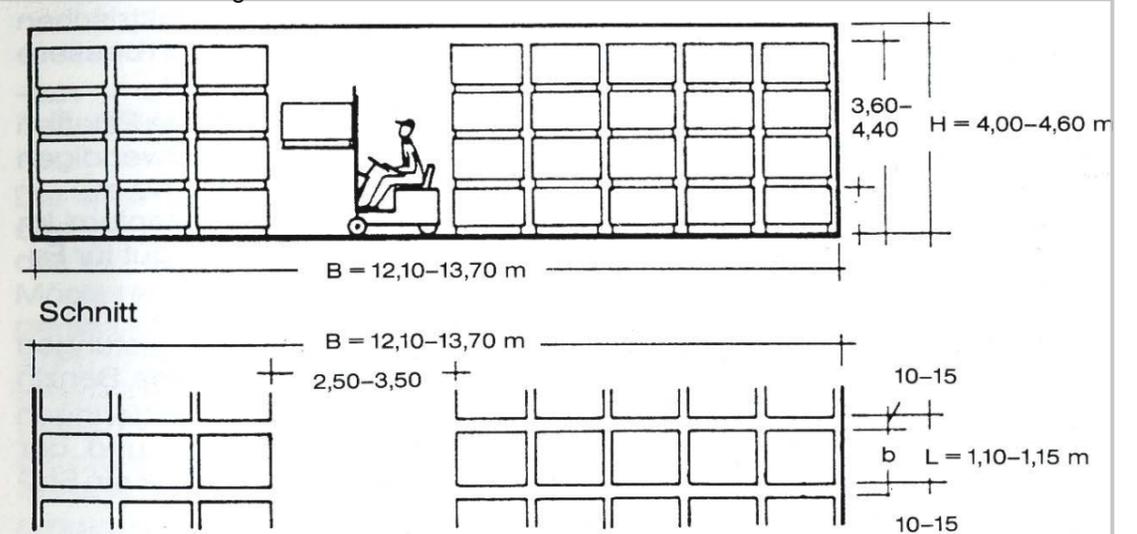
Raumabmessungen in Grundriss und Schnitt für Flaschenlagerung in Boxpaletten bei unterschiedlicher Unterfahrung und Stapelhöhe
